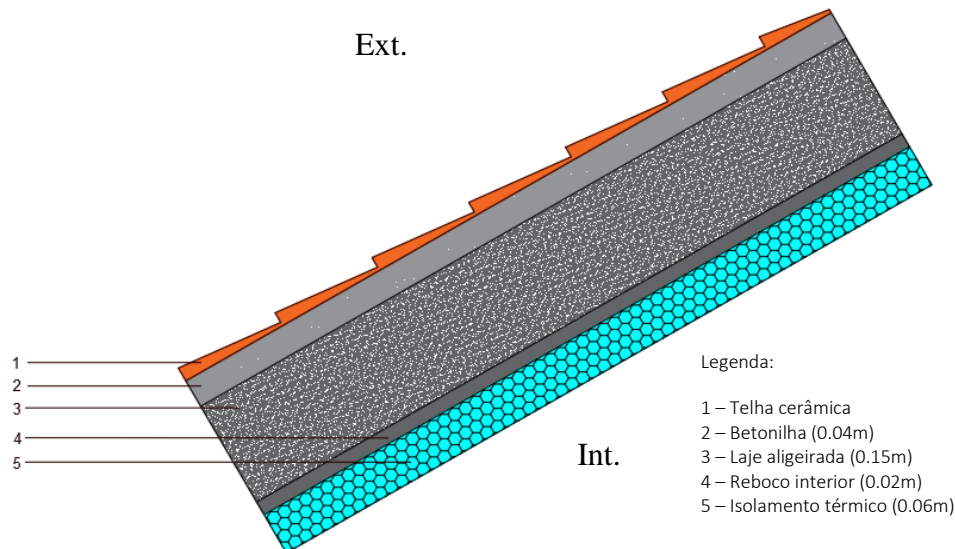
Pormenor construtivo referente à solução construtiva isolamento na vertente vertical na face inferior
